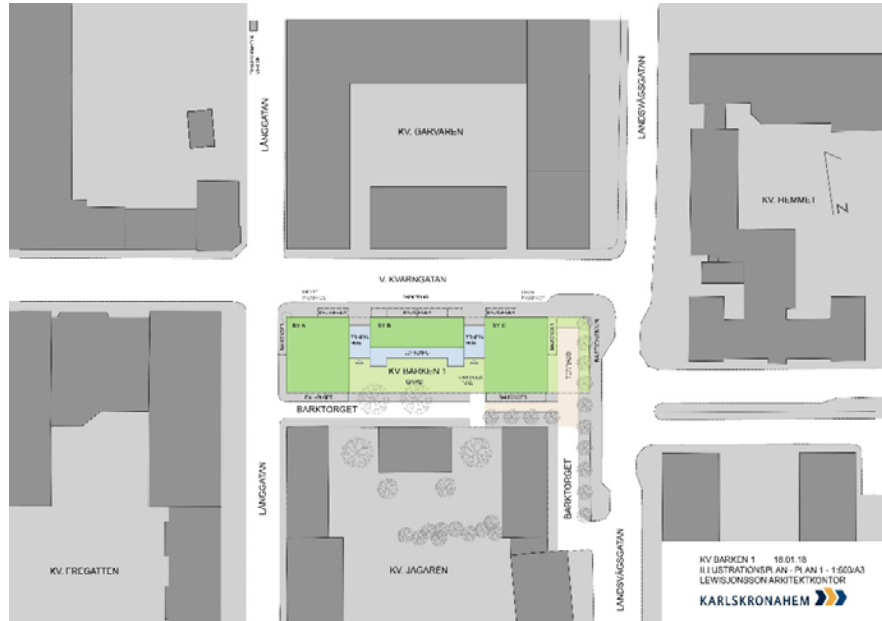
Situationsplan, LewisJonsson Arkitektkontor
